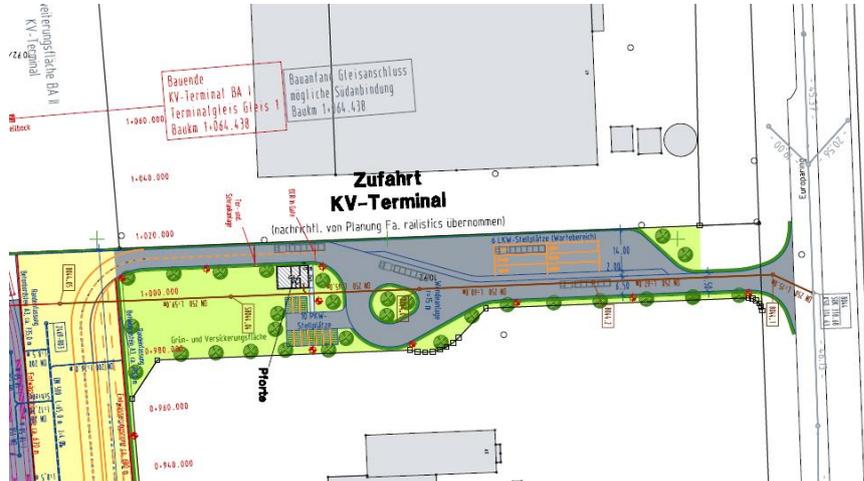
Zufahrt KV-Terminal - Plan 2469_A04_3_L2g_Lageplan der gepl. Anlage _1000
